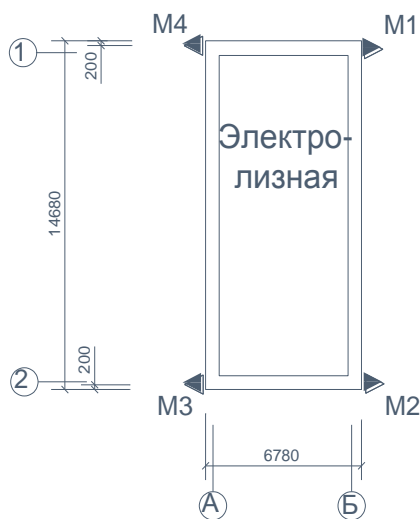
Схема расположения осадочных марок на фундаментах здания Электролизной установки
